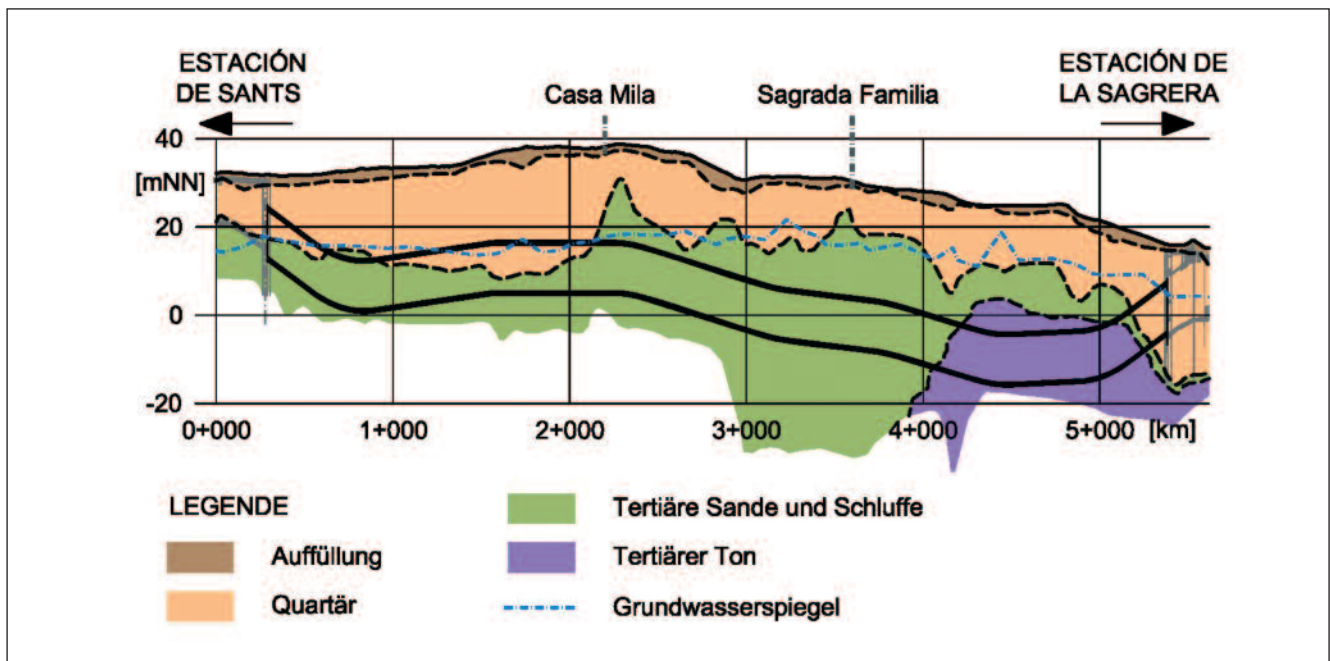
Geotechnischer Längsschnitt AVE-Tunnel
